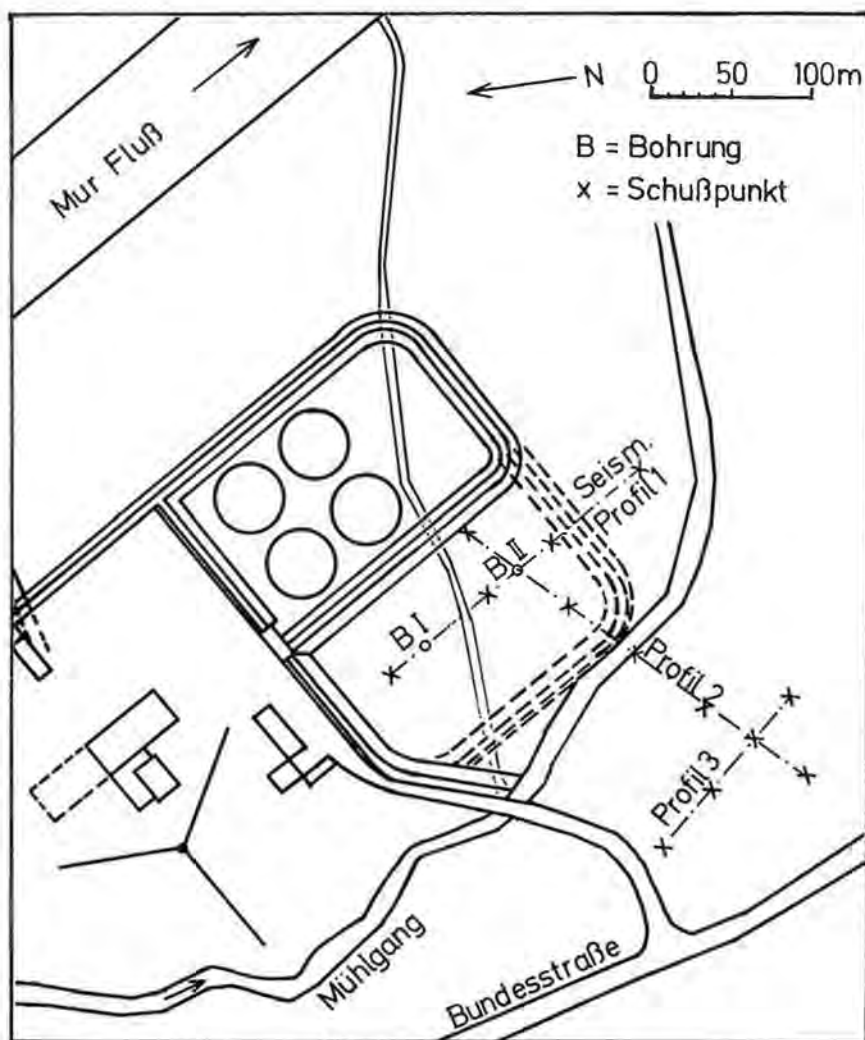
Lageplan Dampfkraftwerk bei Werndorf; strichpunktiert = seismische Profile.
